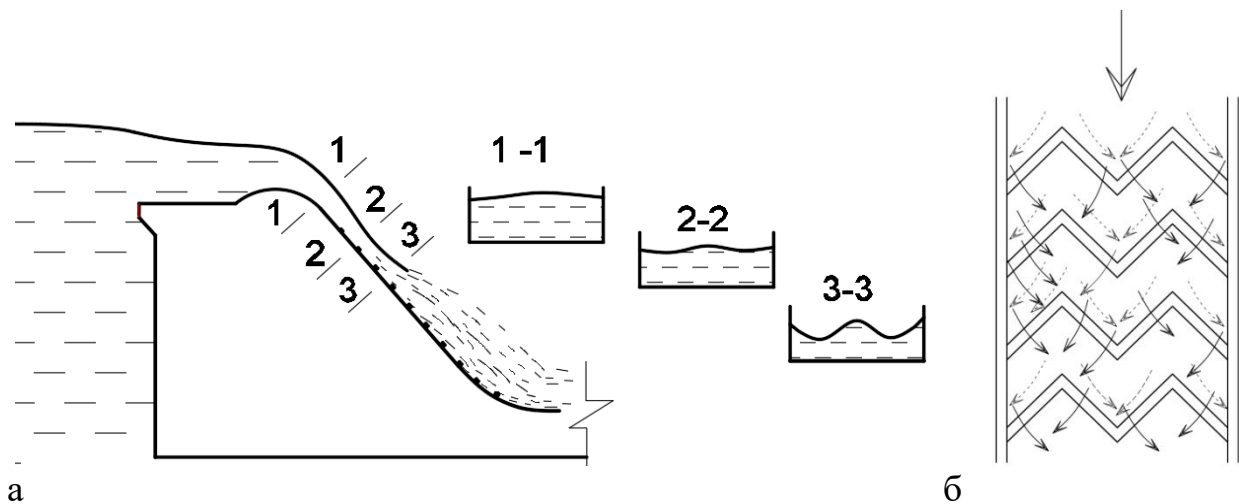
Схемы движения потока при обтекании шероховатости зигзагообразного типа: а - продольный разрез и поперечные сечения водоската; б - соударение поверхностных и донных струй между собой и с боковыми стенками
